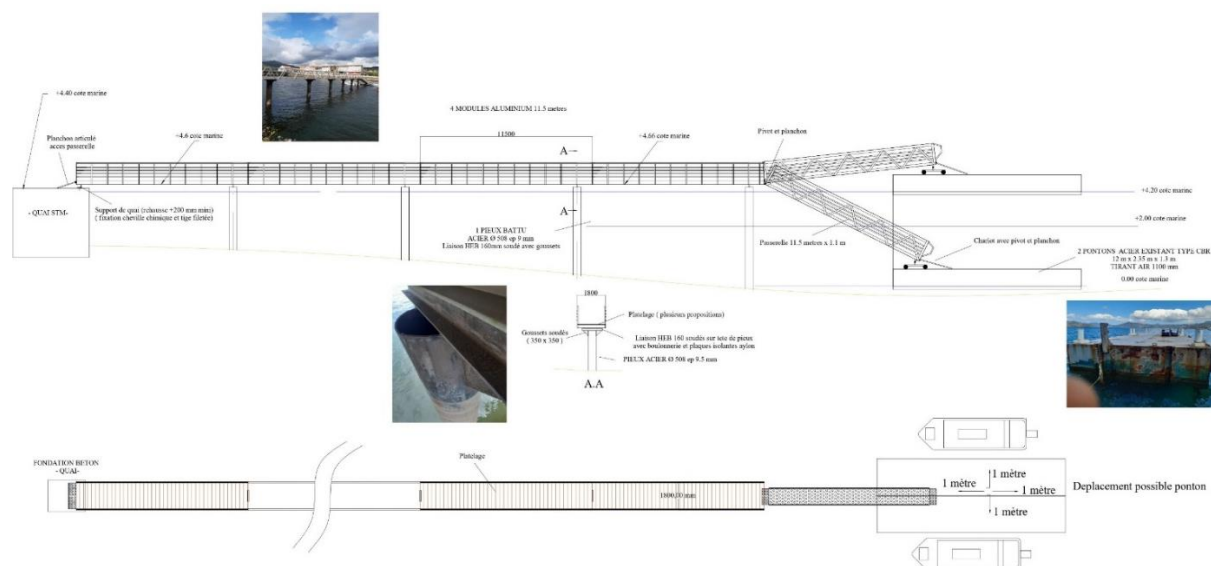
Vue plan du projet du ponton (Source : STMM)
